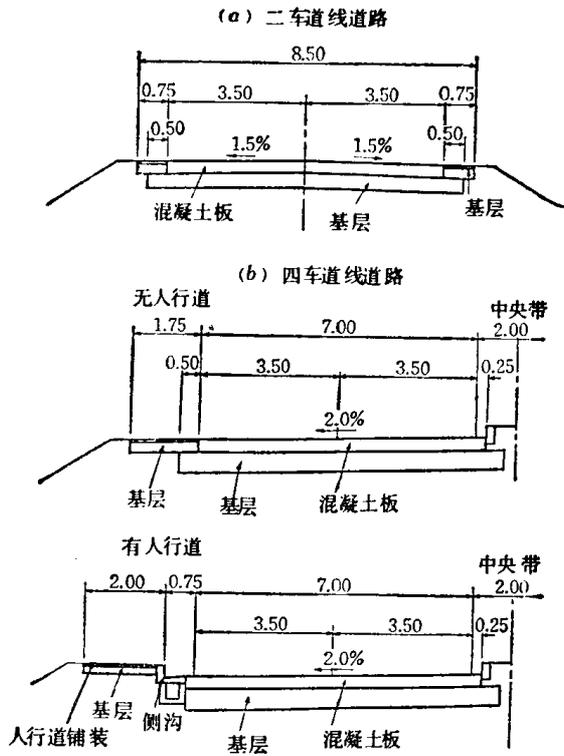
混凝土路面道路的横断面图 (单位: 米)
